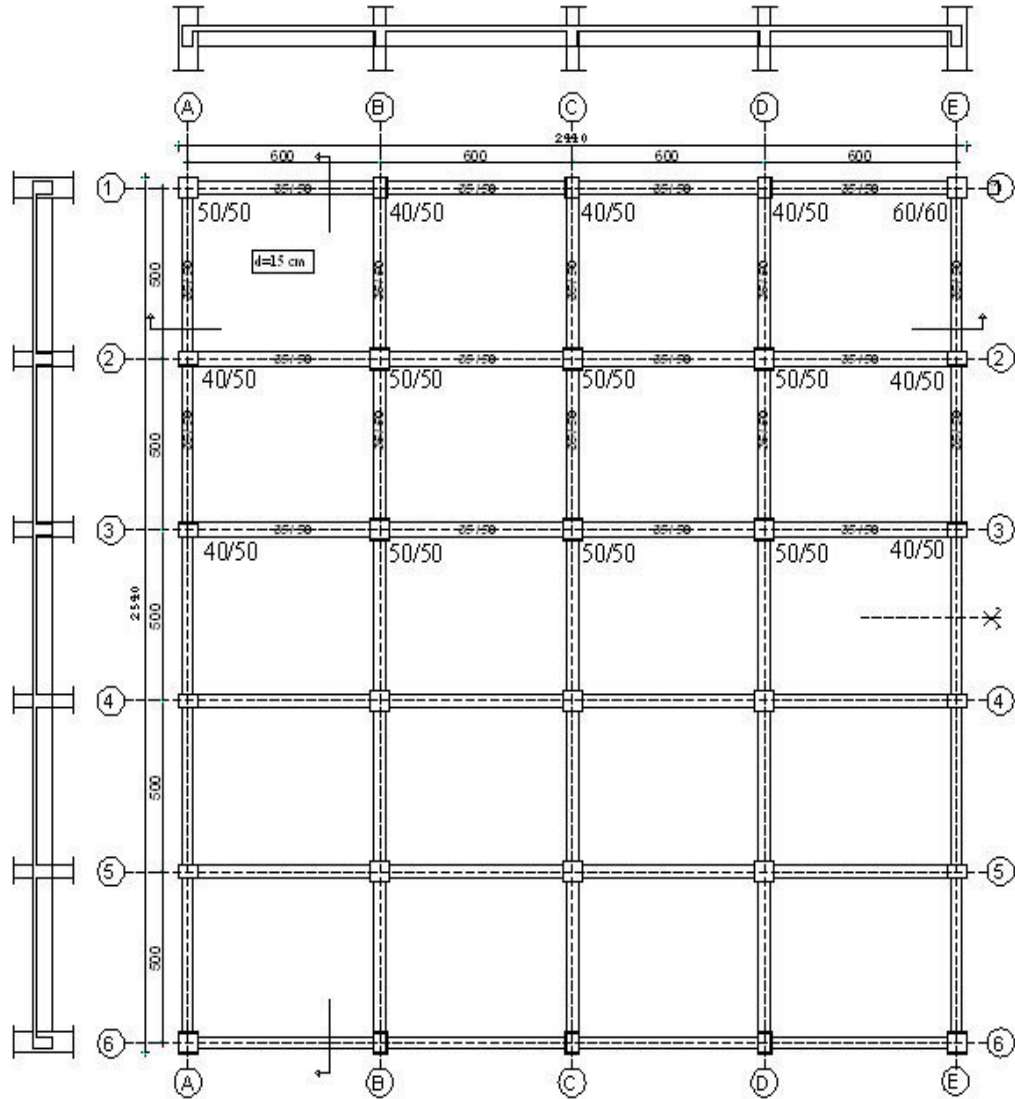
Oluşturulan 9 katlı yapının plan görünüşü.
